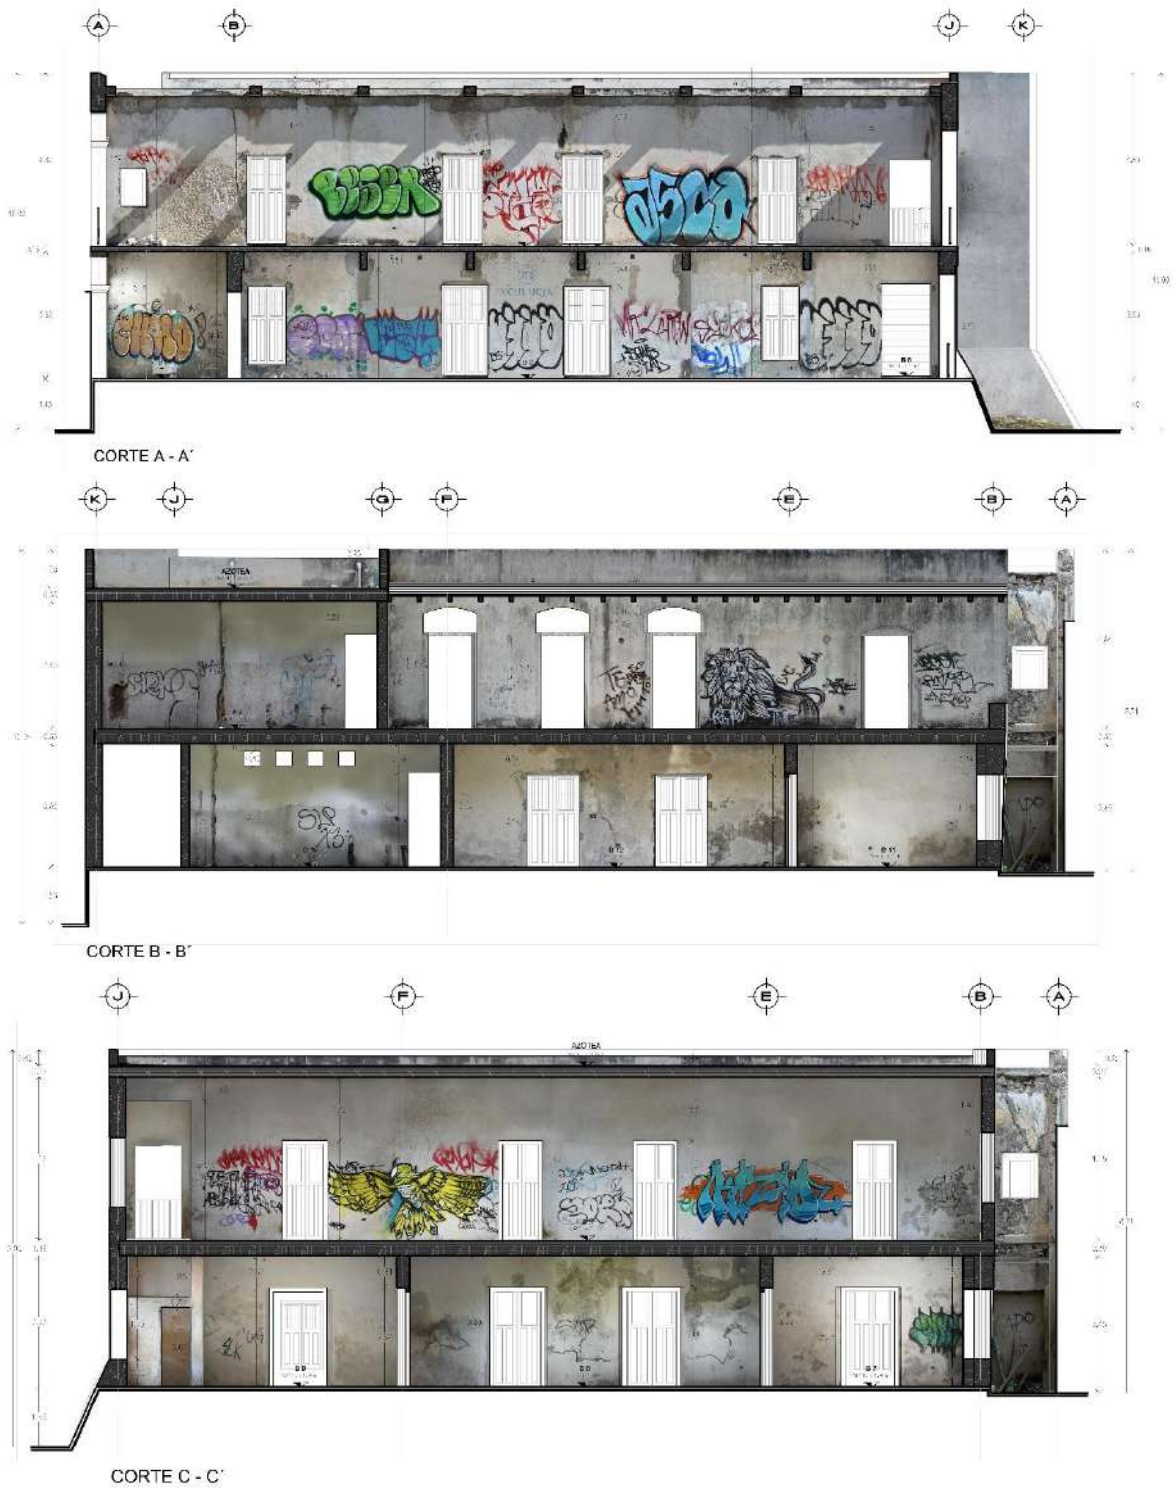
Cortes arquitectónicos longitudinales A, B y C del edificio Xculucya. Fuente: Elaboración propia.
